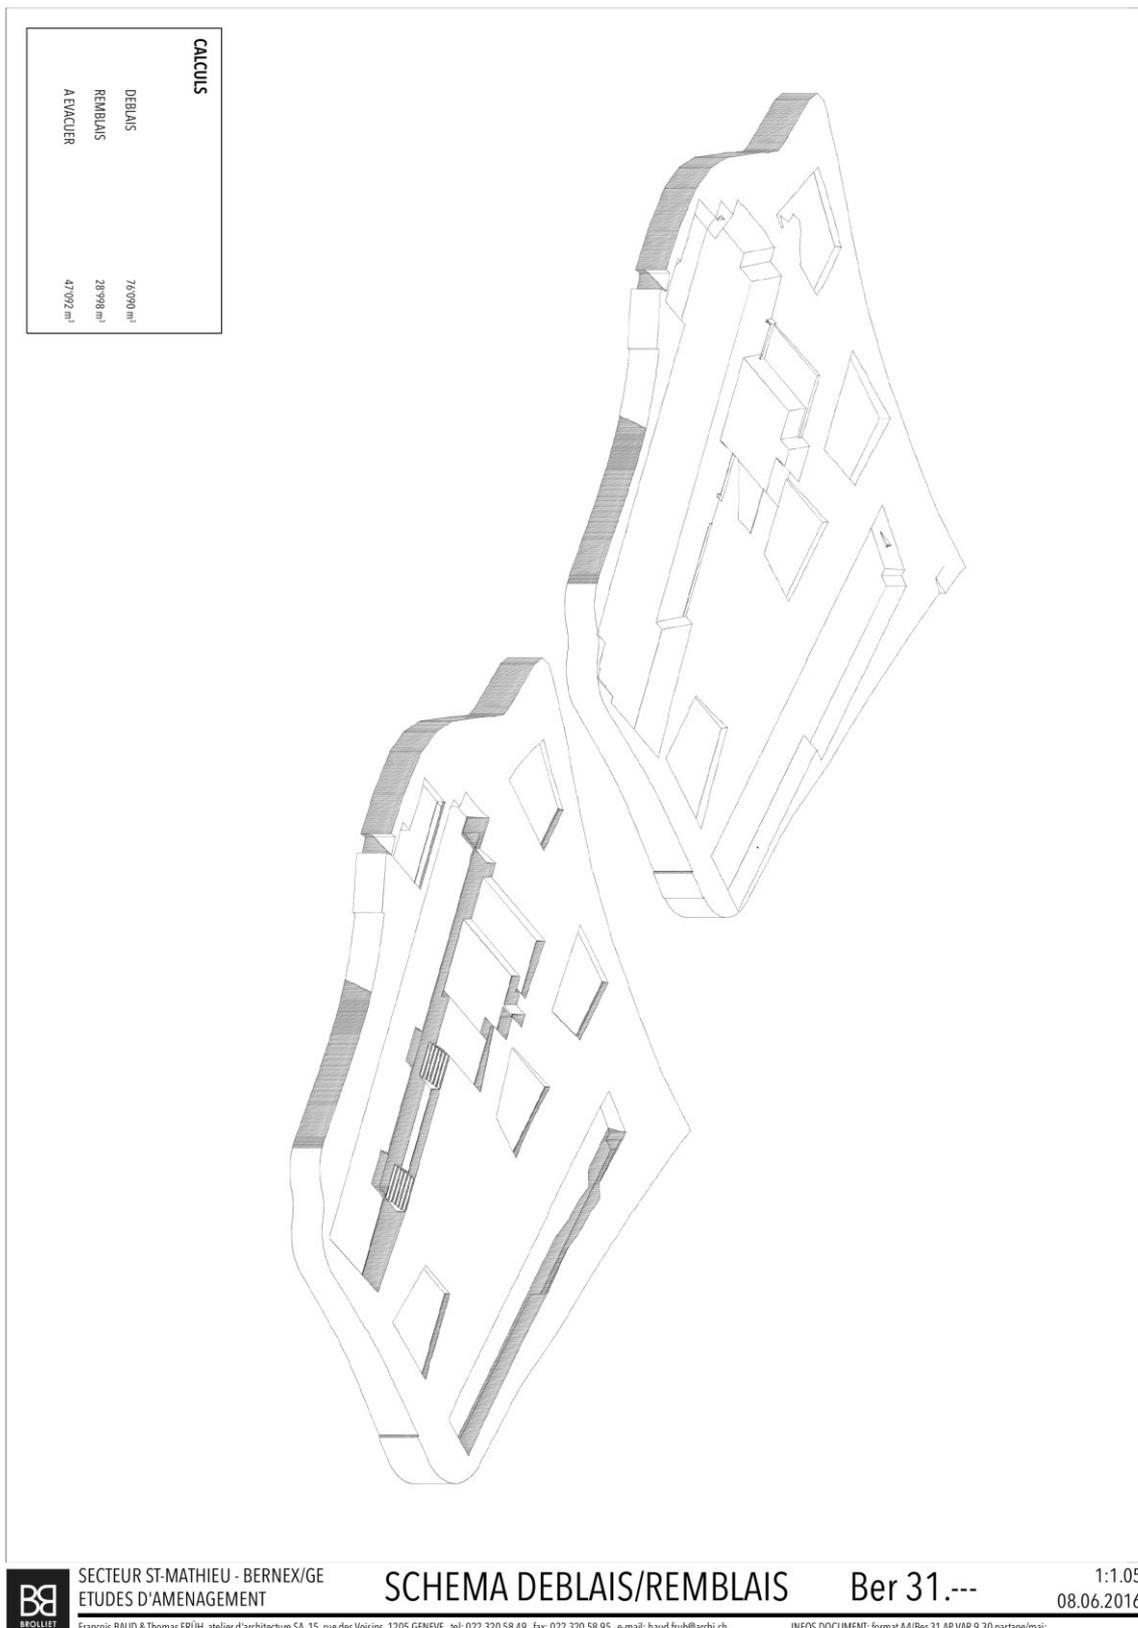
bilan déblais/remblais (Baud&Früh, 08.06.2016)
